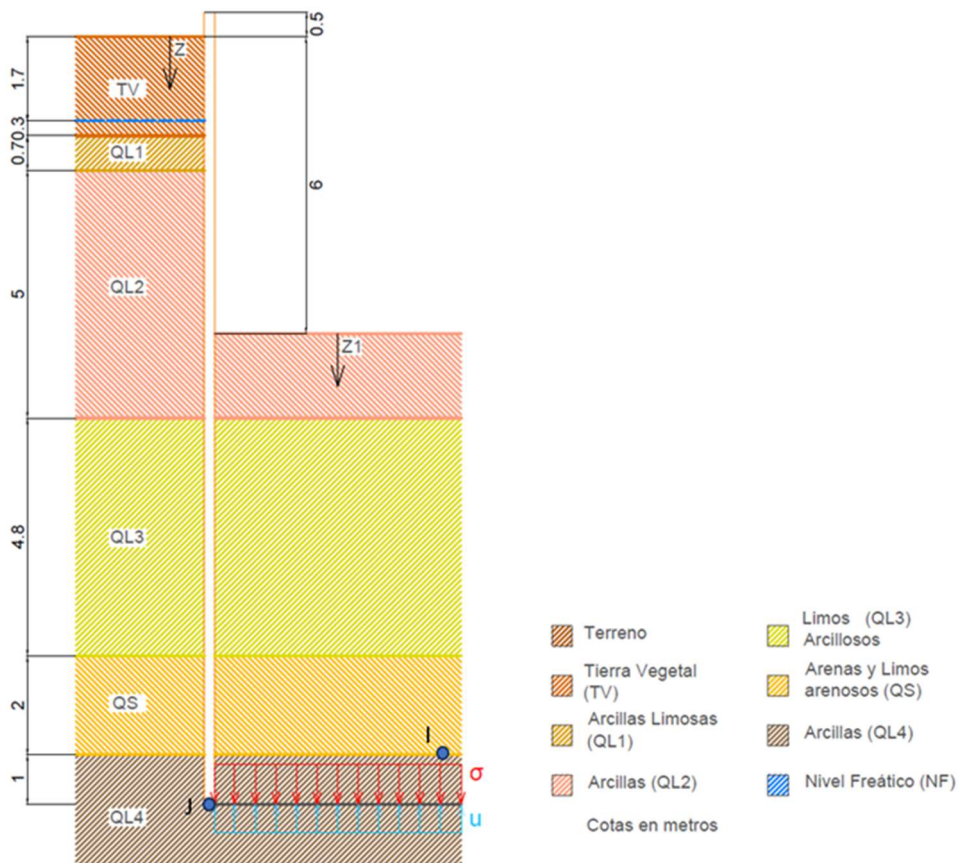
A Levantamiento de Fondo. Fuente: Elaboración propia.
